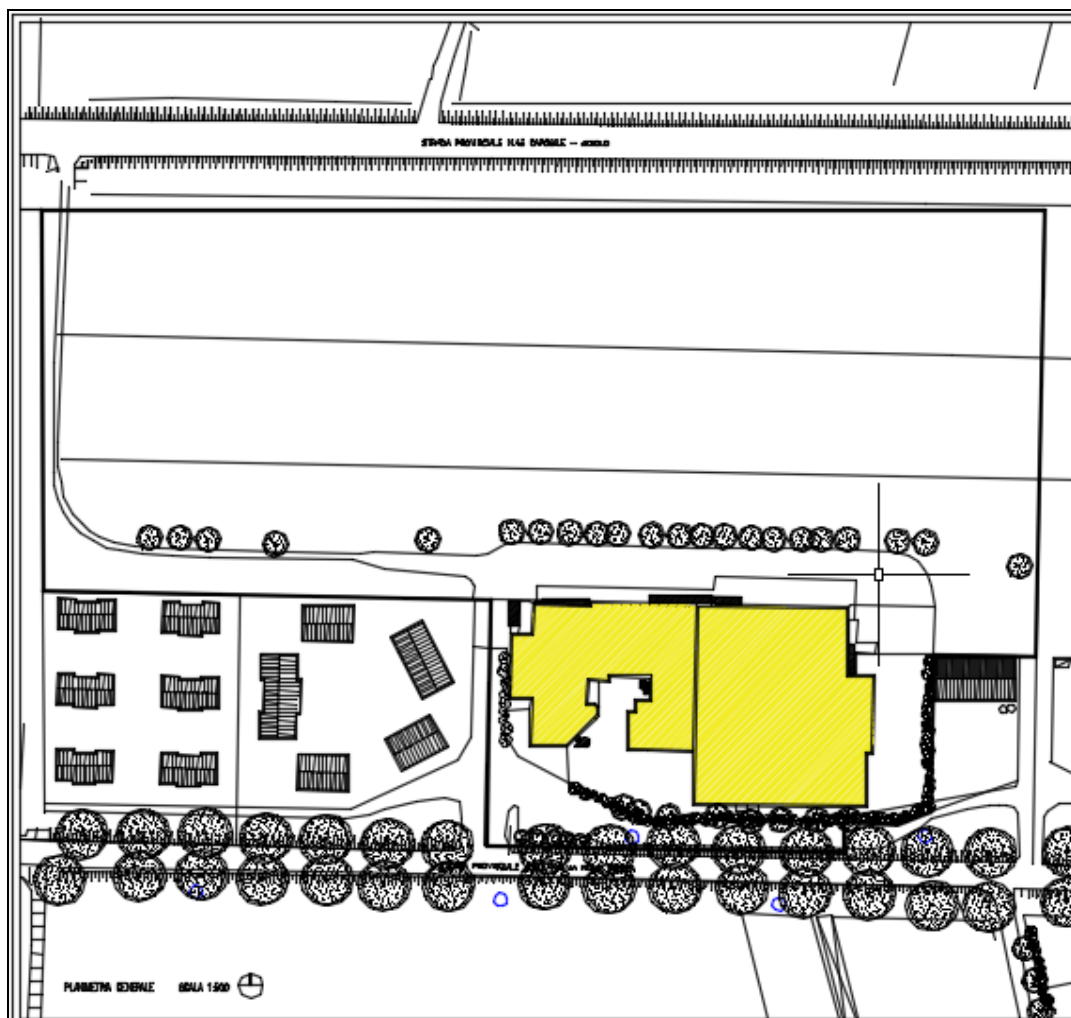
Estratto della Planimetria dello stato di fatto Ambito I.
